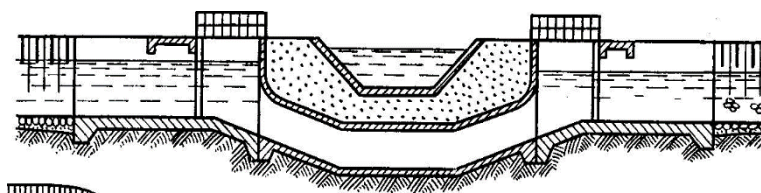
Закрытый дюкер, применяемый при пересечении каналом канала (дороги)
